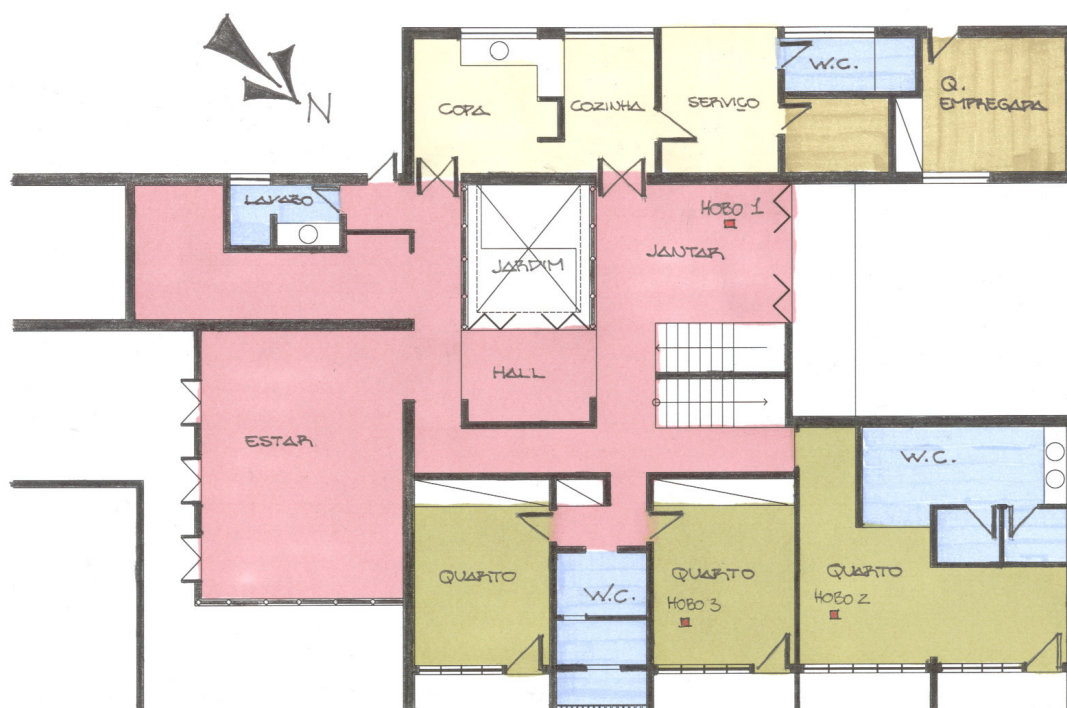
Croqui esquemático da residência 03 – 1º pavimento.
